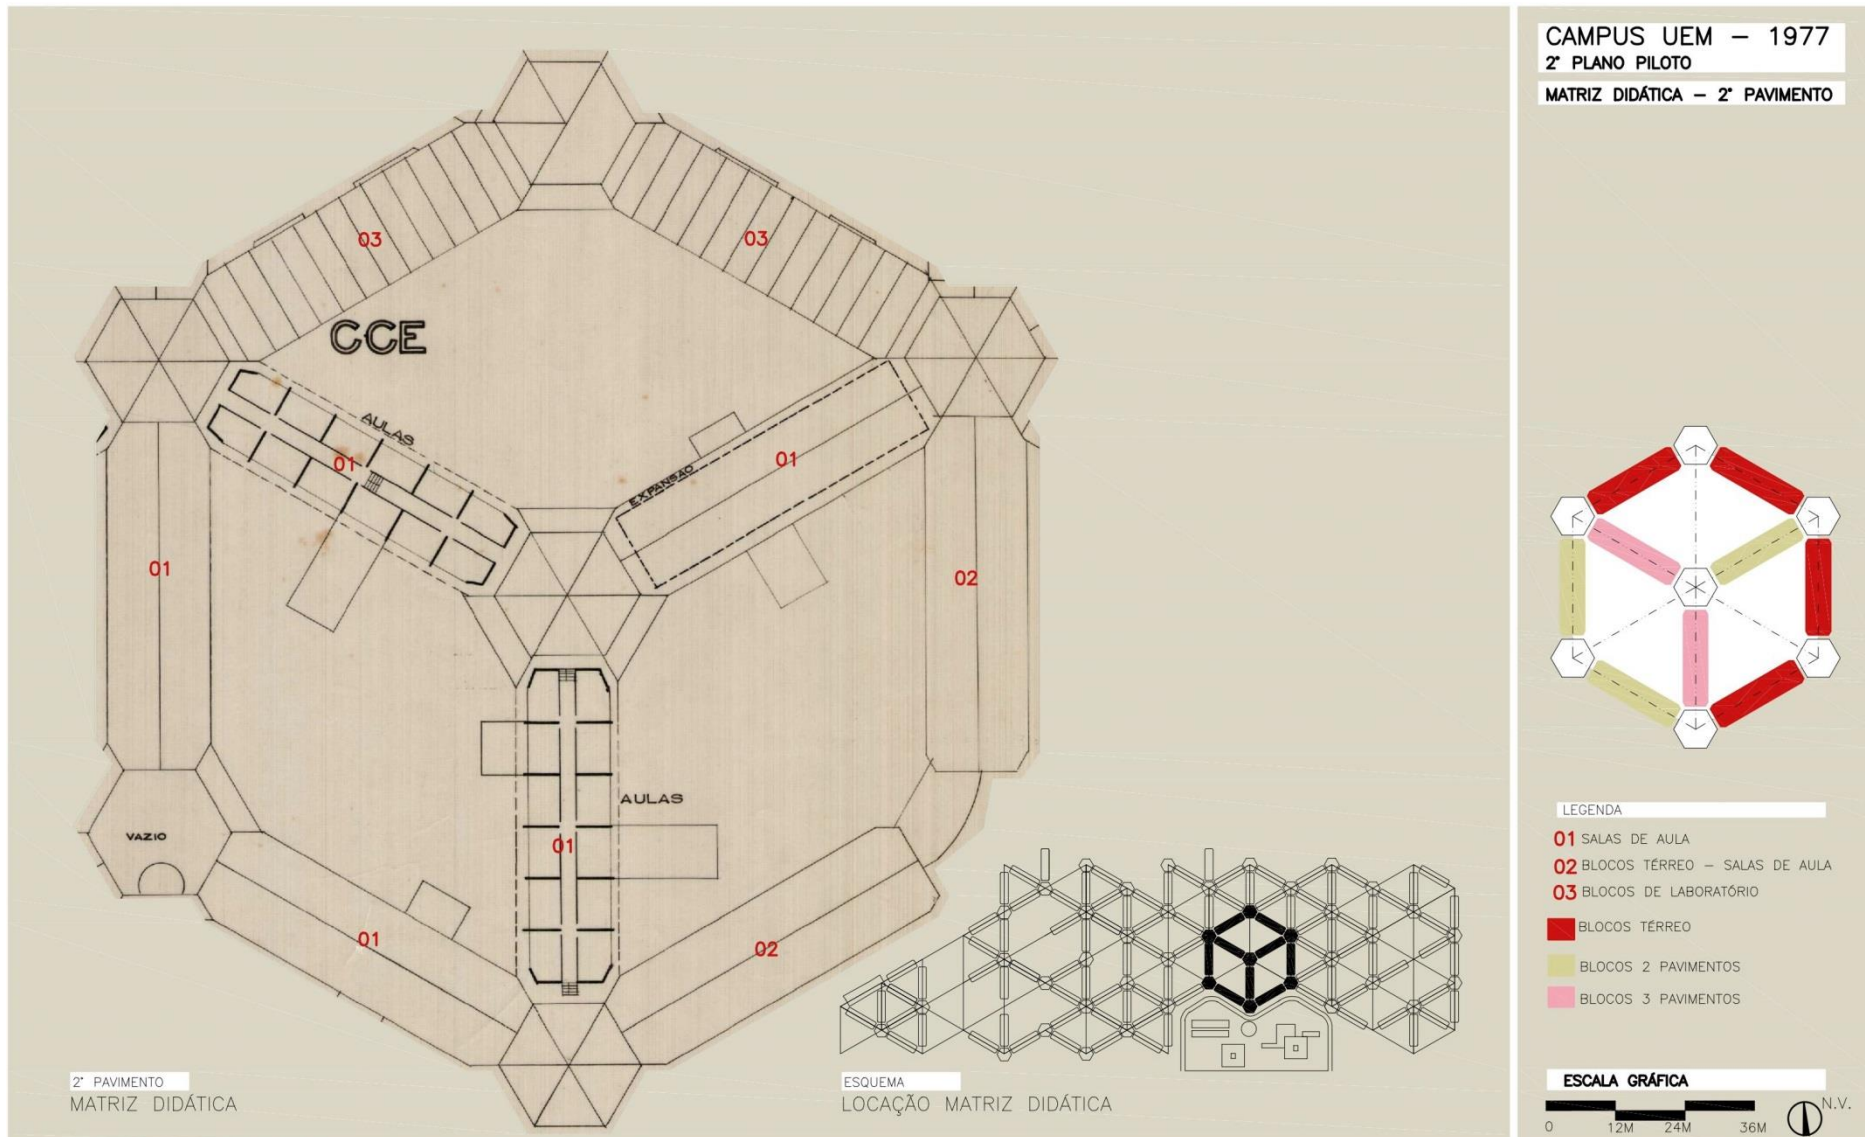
Matriz Didática Segundo Pavimento. Fonte: Mapa Base Prancha 10 – Plano Piloto 1977. Disponível na DOP/PTO. Elaboração Renan Avanci.
